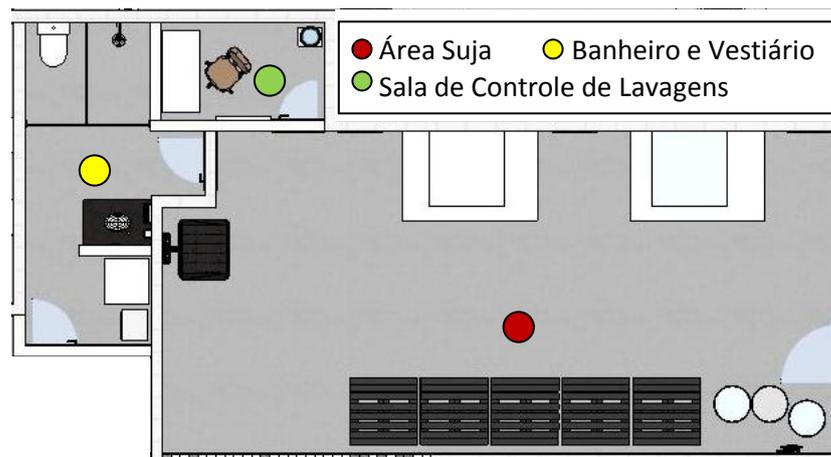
Planta baixa dos setores da lavanderia hospitalar analisada
